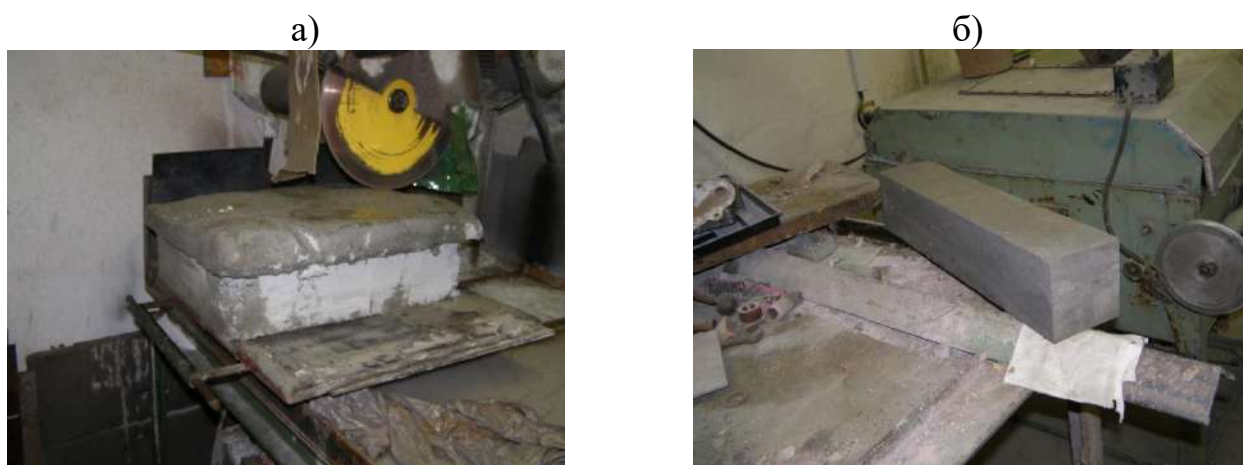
Фото образцов: а – распиловка образца; б – общий вид распиленной балки
